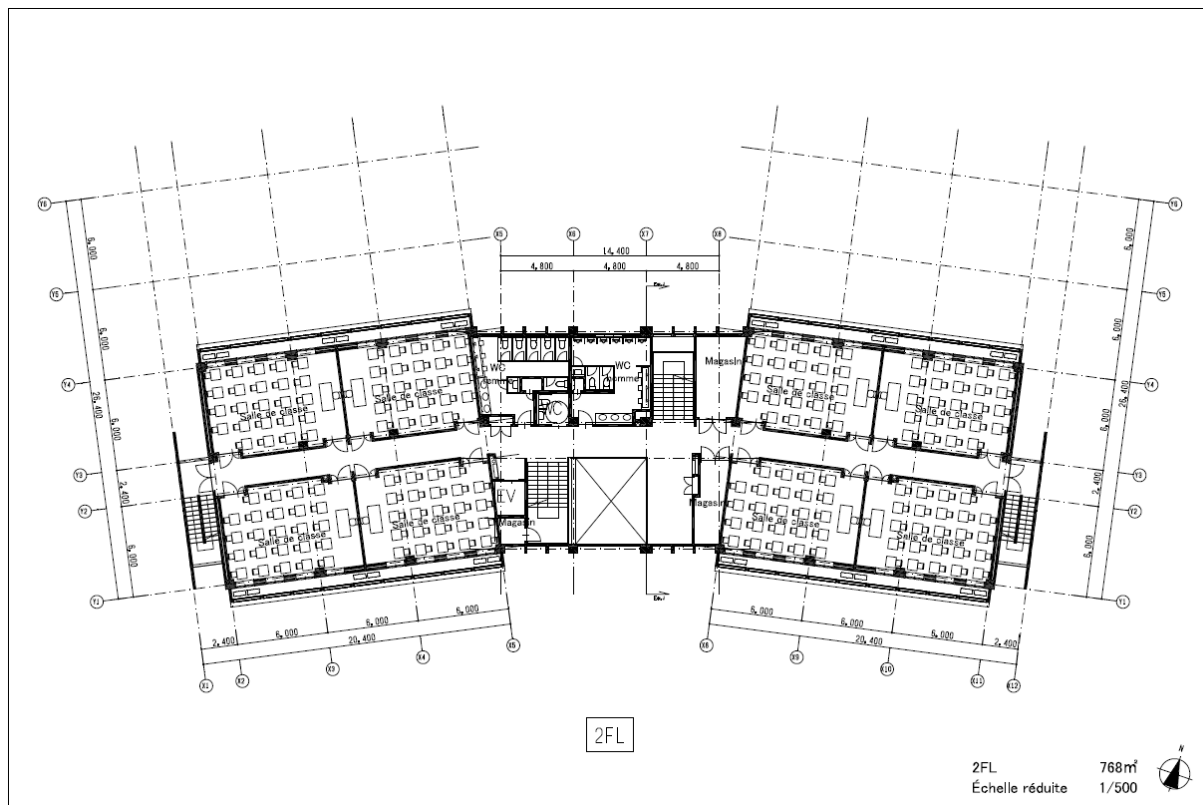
Plan d'étage du bâtiment principal 2e étage
